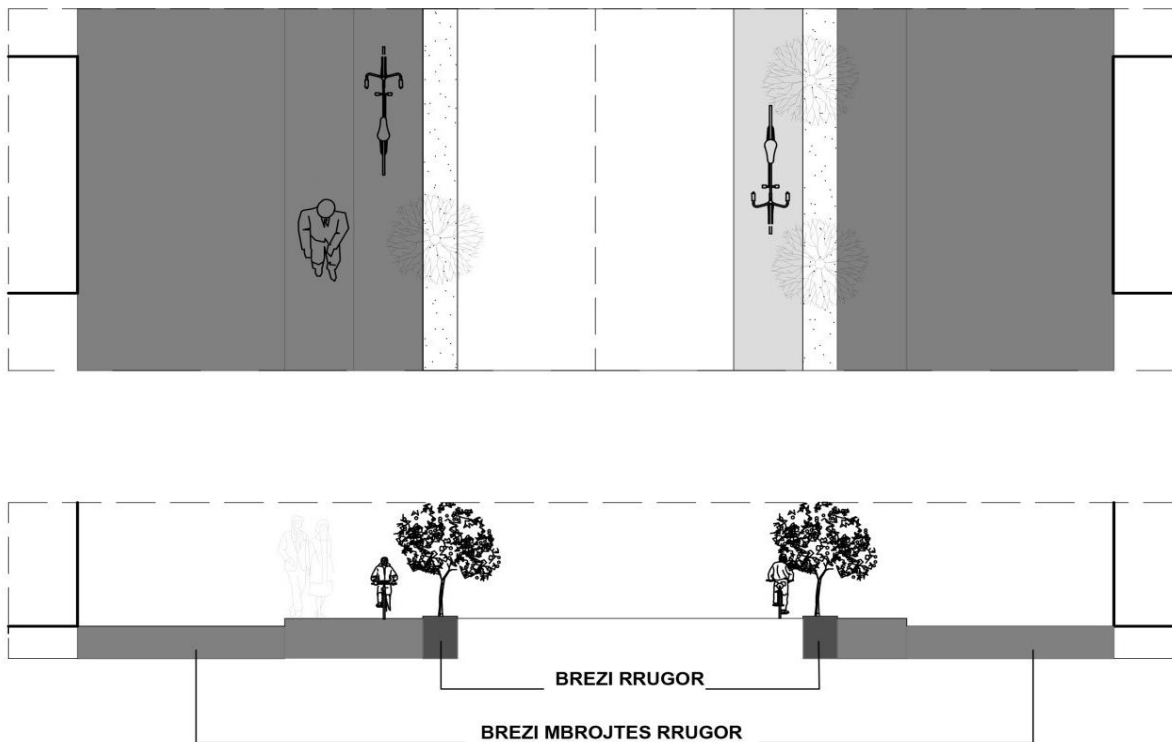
Brezi Mbrojtës dhe Brezi Rrugor
